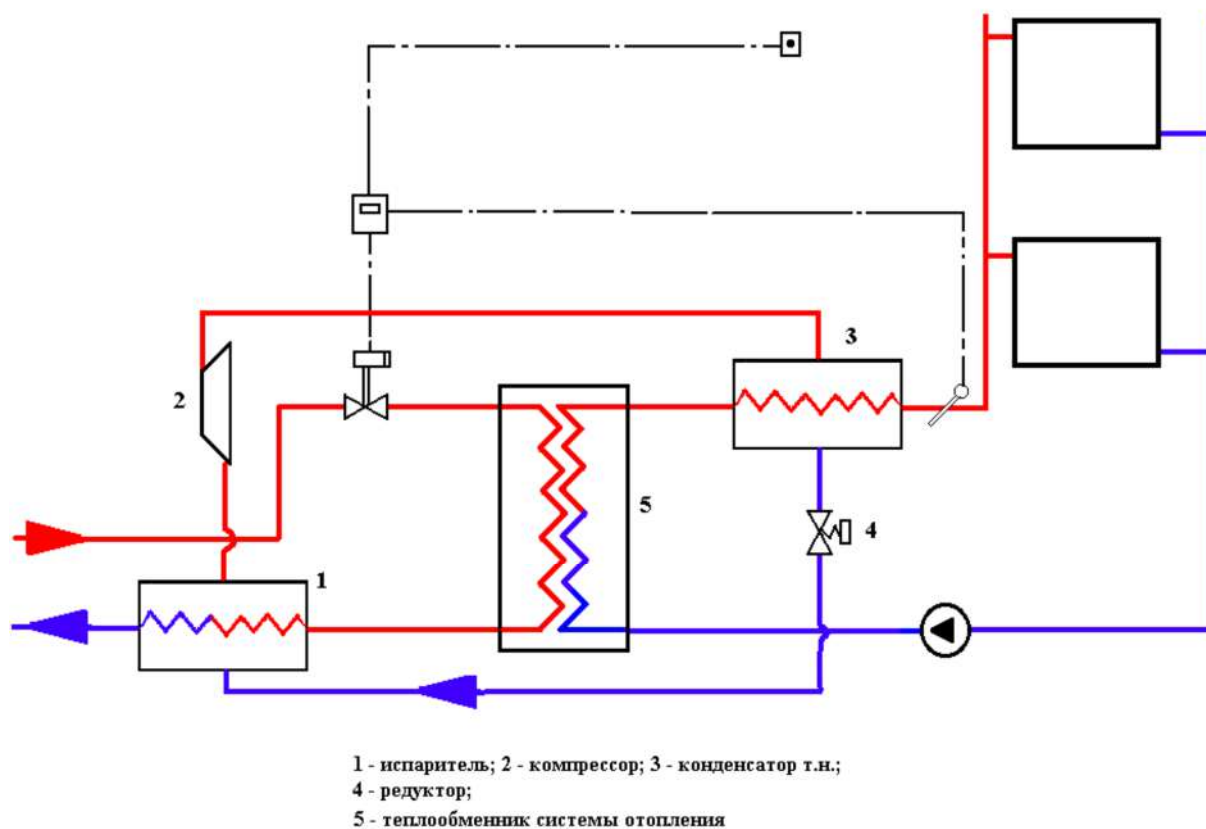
Схема теплового пункта с тепловым насосом с конденсатором на подающем трубопроводе системы отопления
